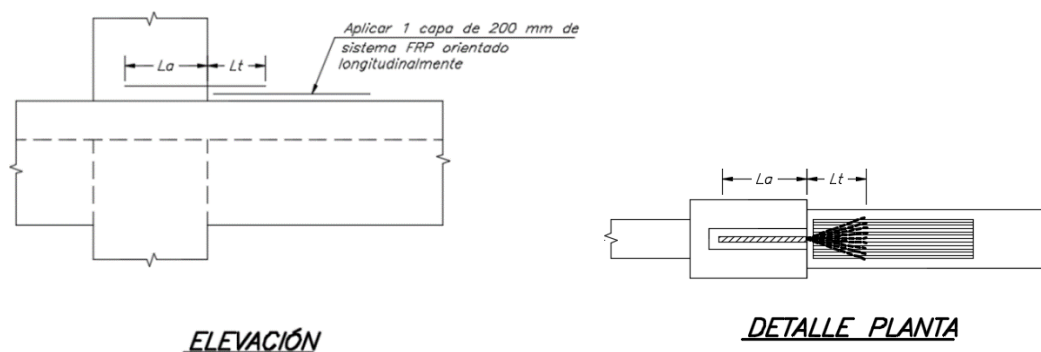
Detalle de refuerzo negativo con anclaje de barra de FRP en columna.
